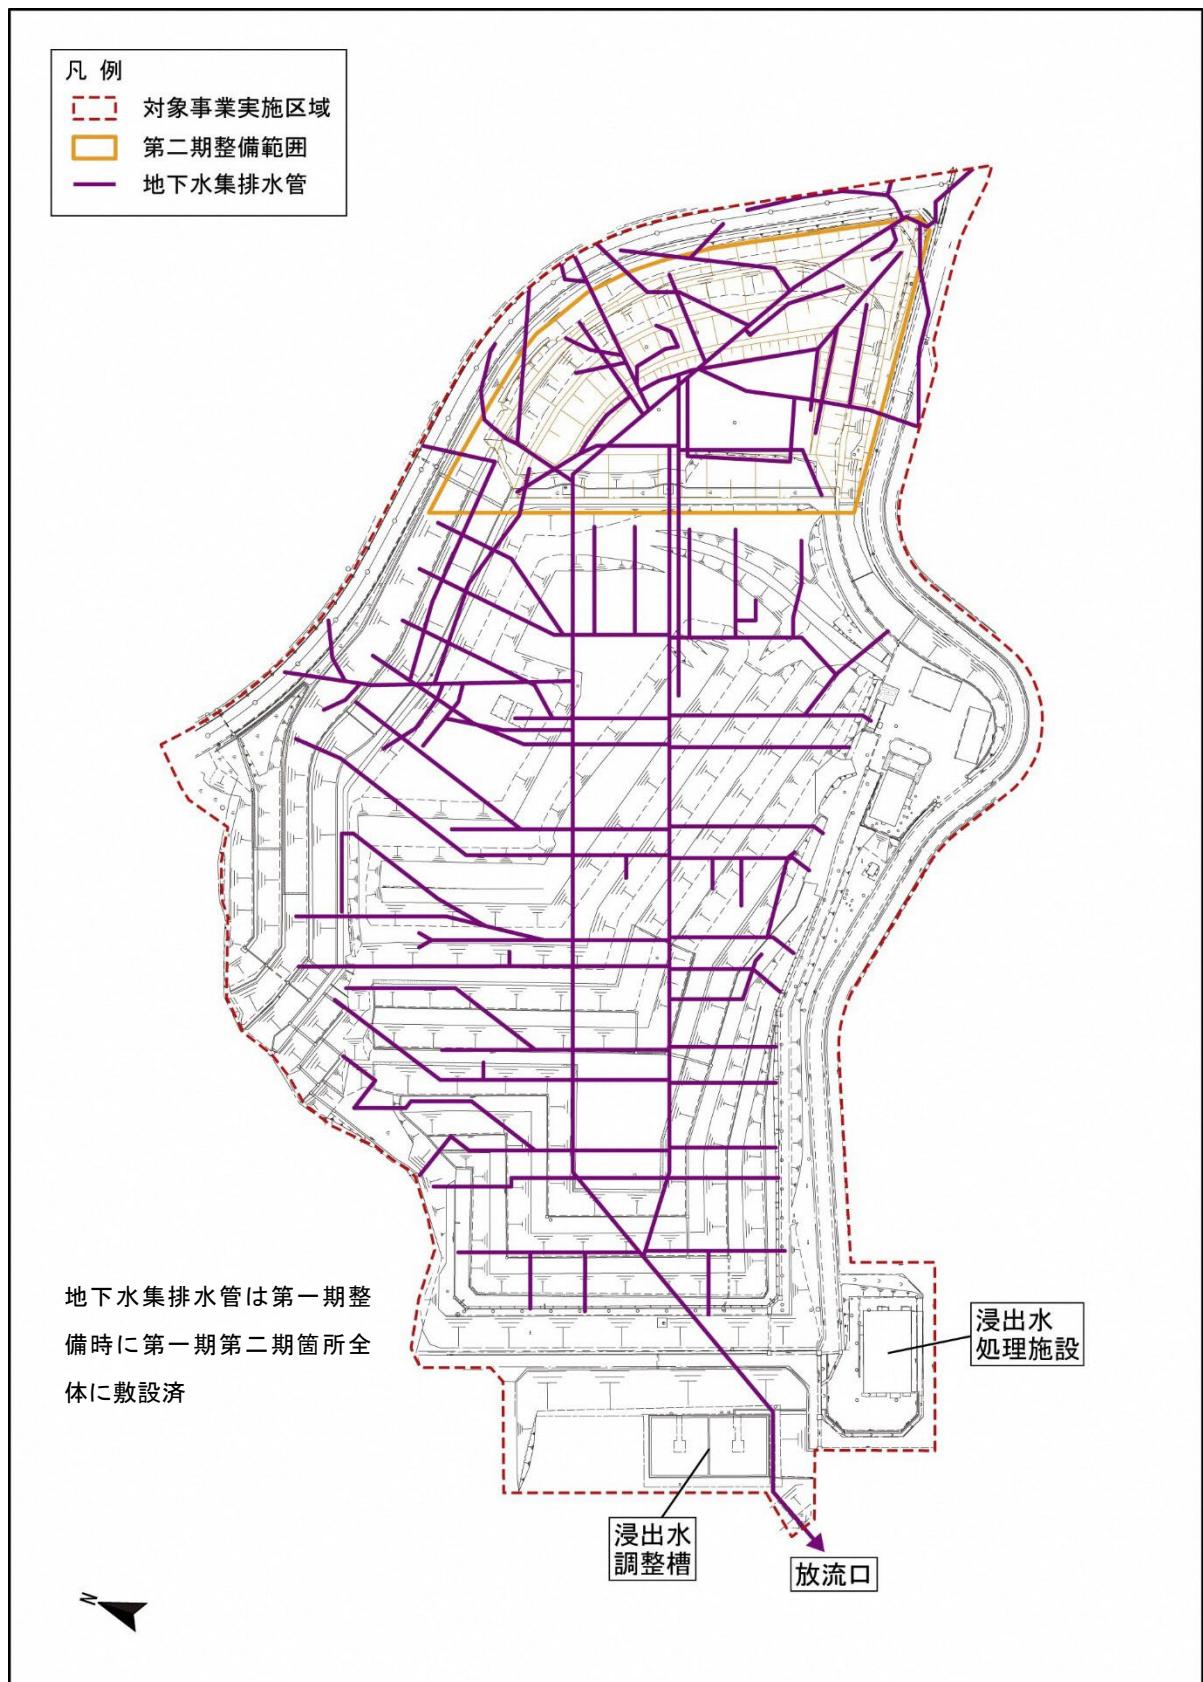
(3) 集排水設備計画平面図（地下水集排水設備）
